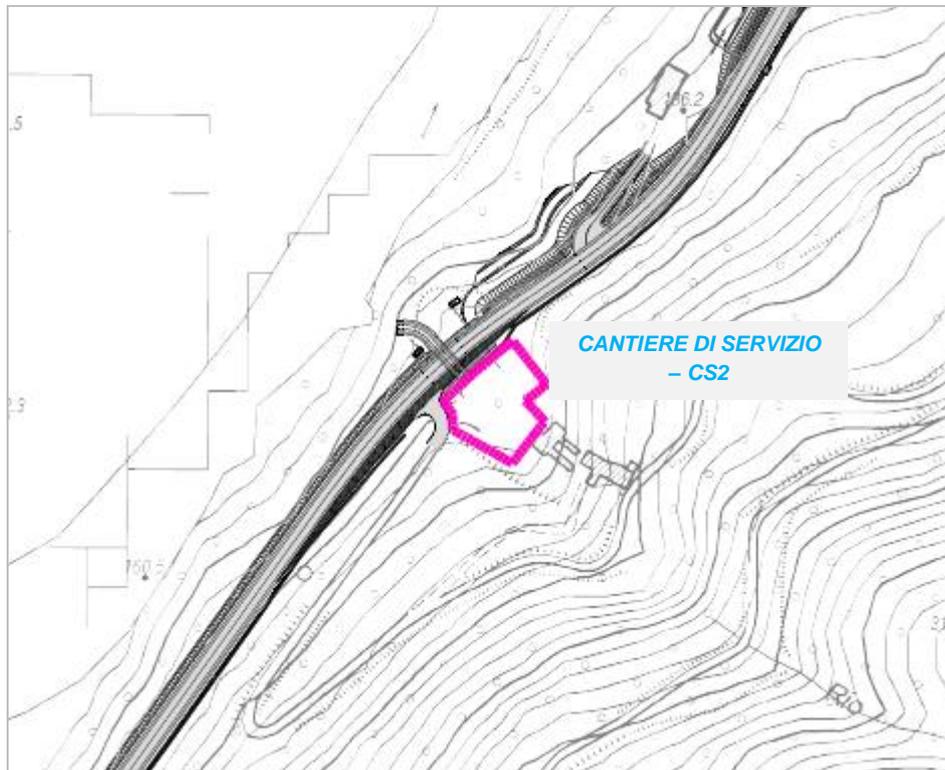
PLANIMETRIA CANTIERE DI SERVIZIO CS2
